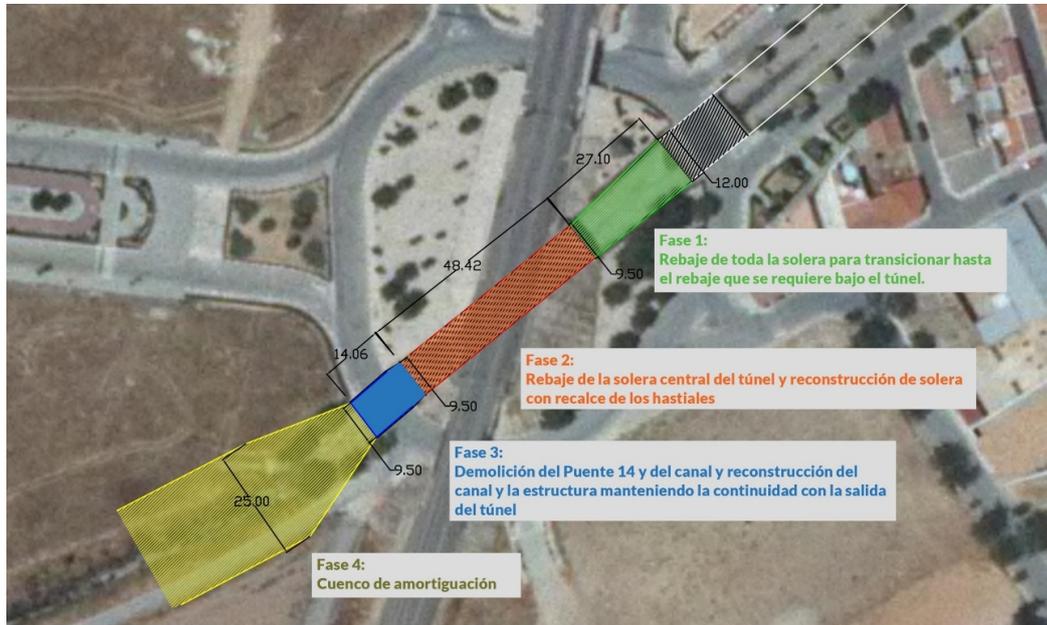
Imagen en planta de las zonas a distinguir en la ejecución de la medida propuesta en la zona del puente del FFCC..
